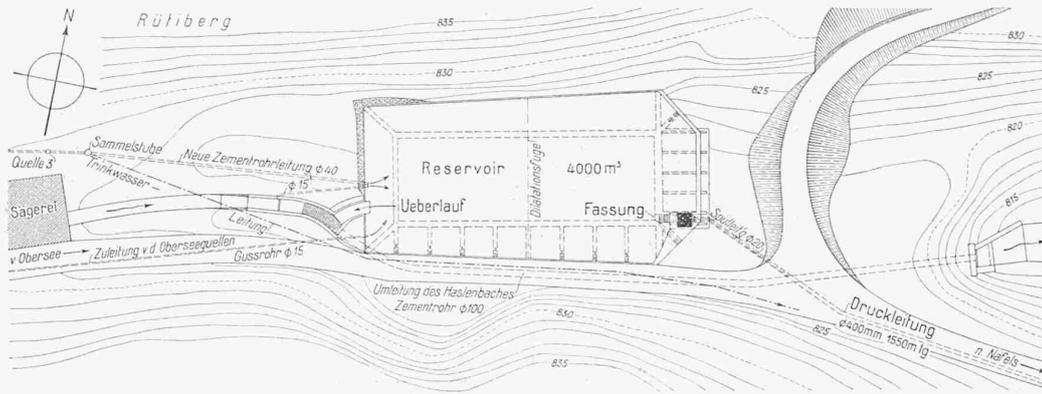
Lageplan des Ausgleichbeckens auf dem Rütliberg oberhalb Näfels. — Masstab 1 : 1000.
